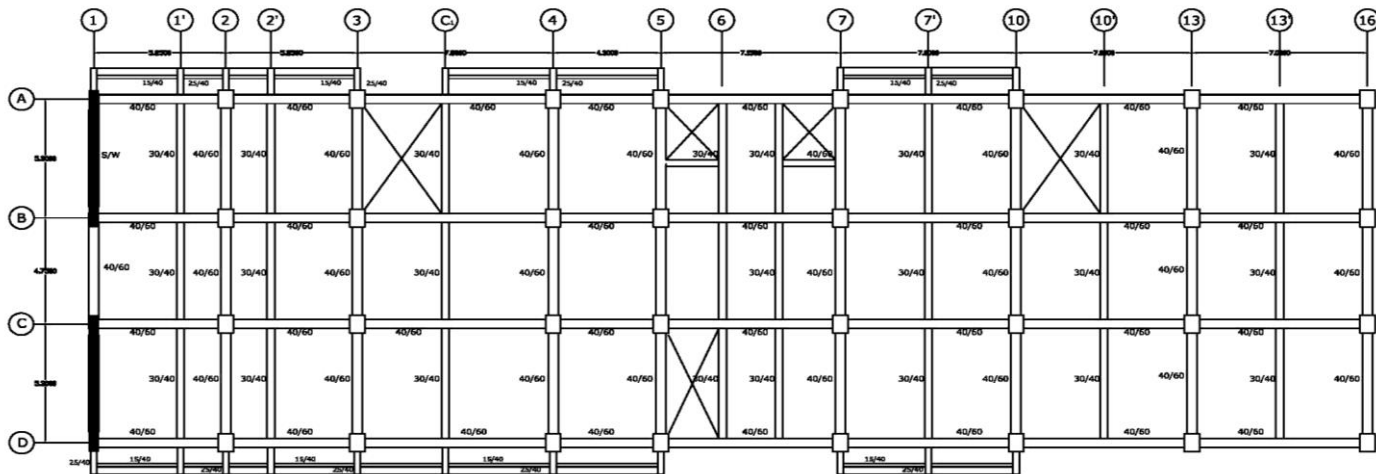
Denah Pembalokan Lantai 3 - 8
